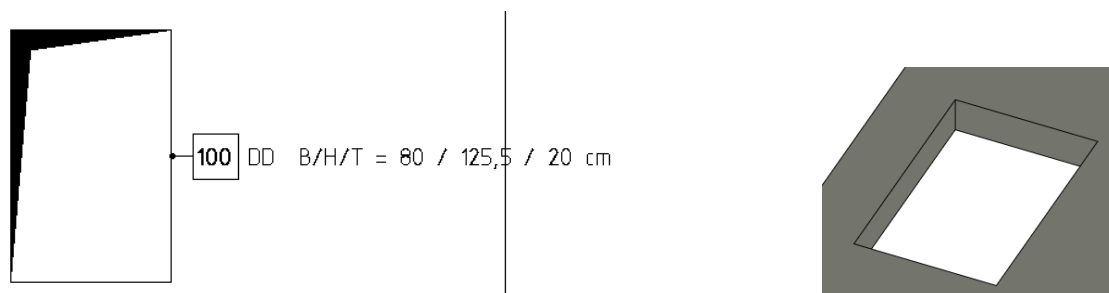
Darstellung einer Deckenöffnung inkl. Beschriftung
